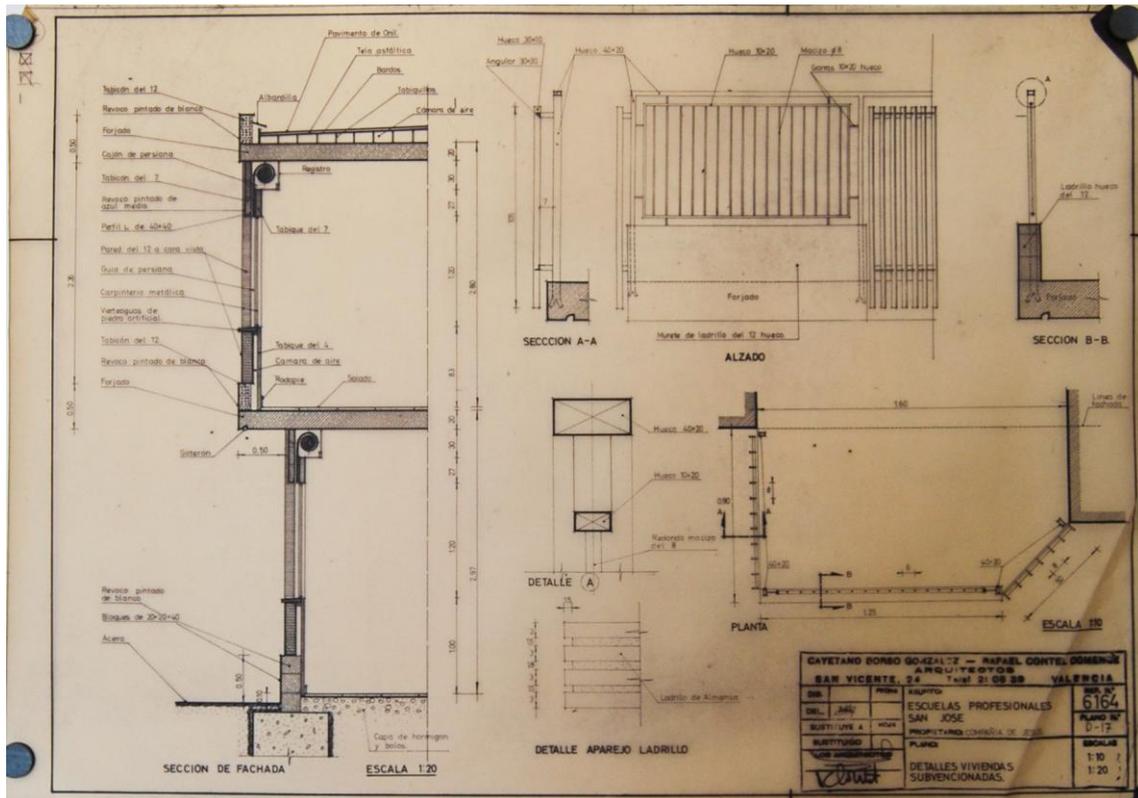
Sección constructiva y de detalles de la vivienda. Archivo Escuelas San José.
